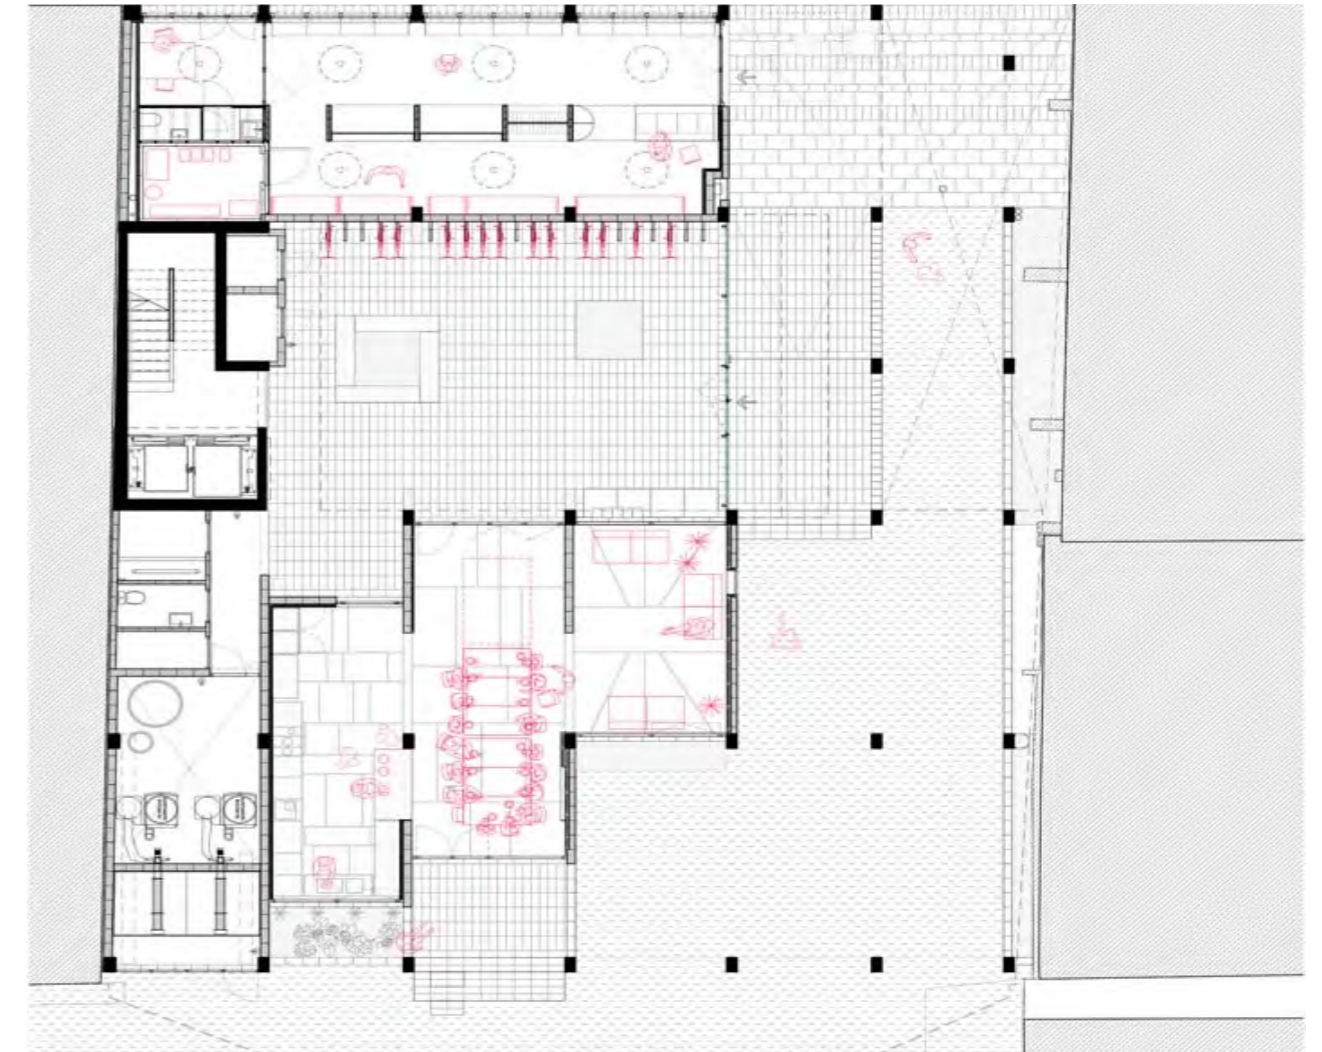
Planta baja integración de espacios comunales Fuente: Lluc Miralles, 2018.
